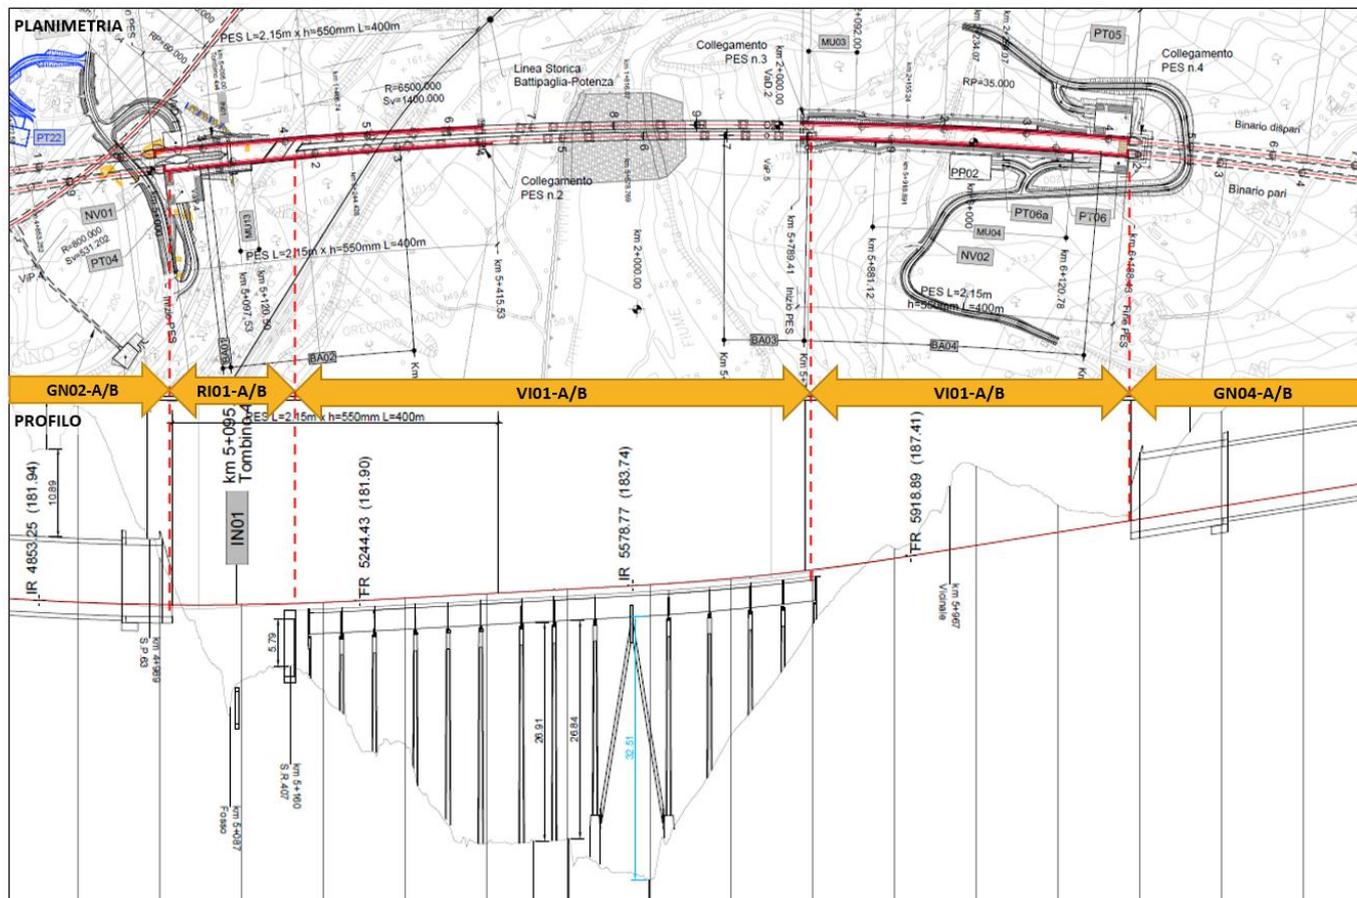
Planoprofilo di progetto da km 5+015 a km 6+800 BP
